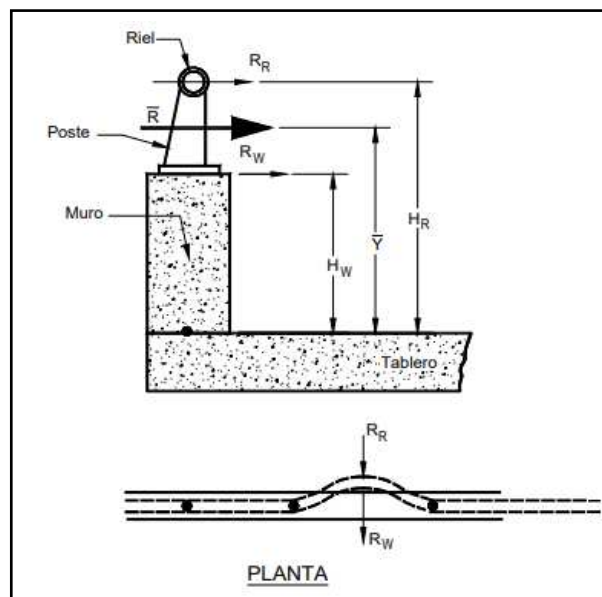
Análisis del conjunto formado por un muro de hormigón y un riel metálico con un impacto a la mitad de la longitud de la protección
